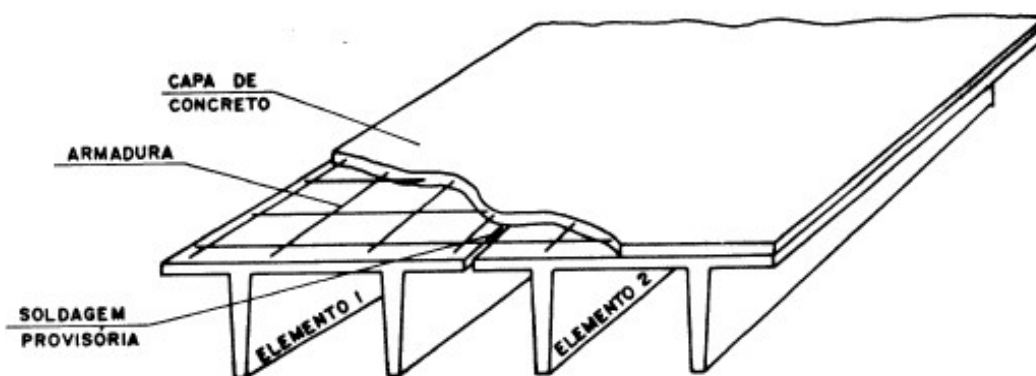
Detalhe ligação laje “duplo T” com laje “duplo T” (Ballarin, 1993)
